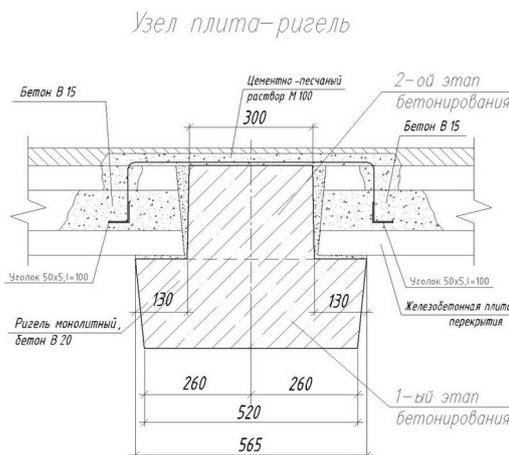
Узел сопряжения монолитного ригеля с плитой перекрытия
